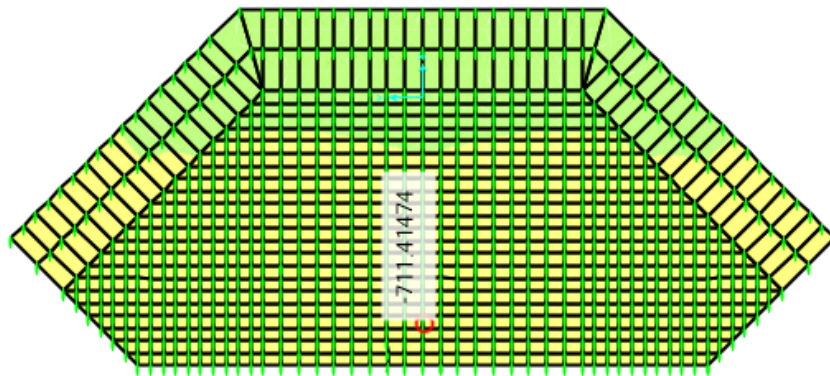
Verificación de esfuerzos a compresión del concreto en la parte inferior de la zapata - para el eje local 1
